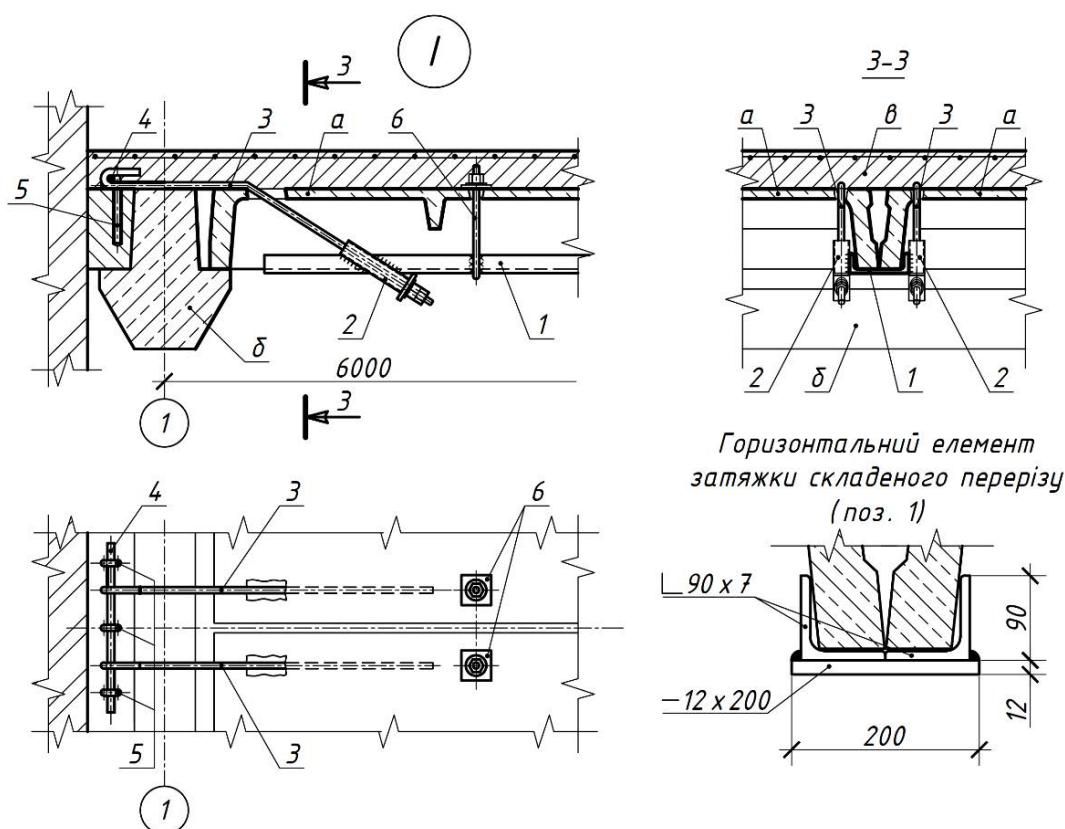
Конструктивне рішення підсилення ребристих плит перекриття поблизу крайньої опори плит на збірні залізобетонні ригелі таврового перерізу: 1 – горизонтальний елемент зтяжки (швелер № 33 або складеного перерізу); 2 – вузол кріплення похилого елемента до горизонтального елемента зтяжки (труба 80x80x7 мм; полоса – 12x100x100 мм); 3 – похилий елемент зтяжки (стержень Ø56 мм); 4 – горизонтальний елемент кріплення похилих елементів зтяжки до анкерних елементів (стержень Ø32 мм); 5 – анкерний елемент кріплення зтяжки на крайній опорі перекриття; 6 – вертикальний Г-подібний елемент кріплення горизонтального елемента зтяжки (стержень Ø20 мм); а – існуюча ребриста плита перекриття; б – ригель; в – монолітний залізобетонний шар набетонування, що влаштовується зверху плити для її підсилення
